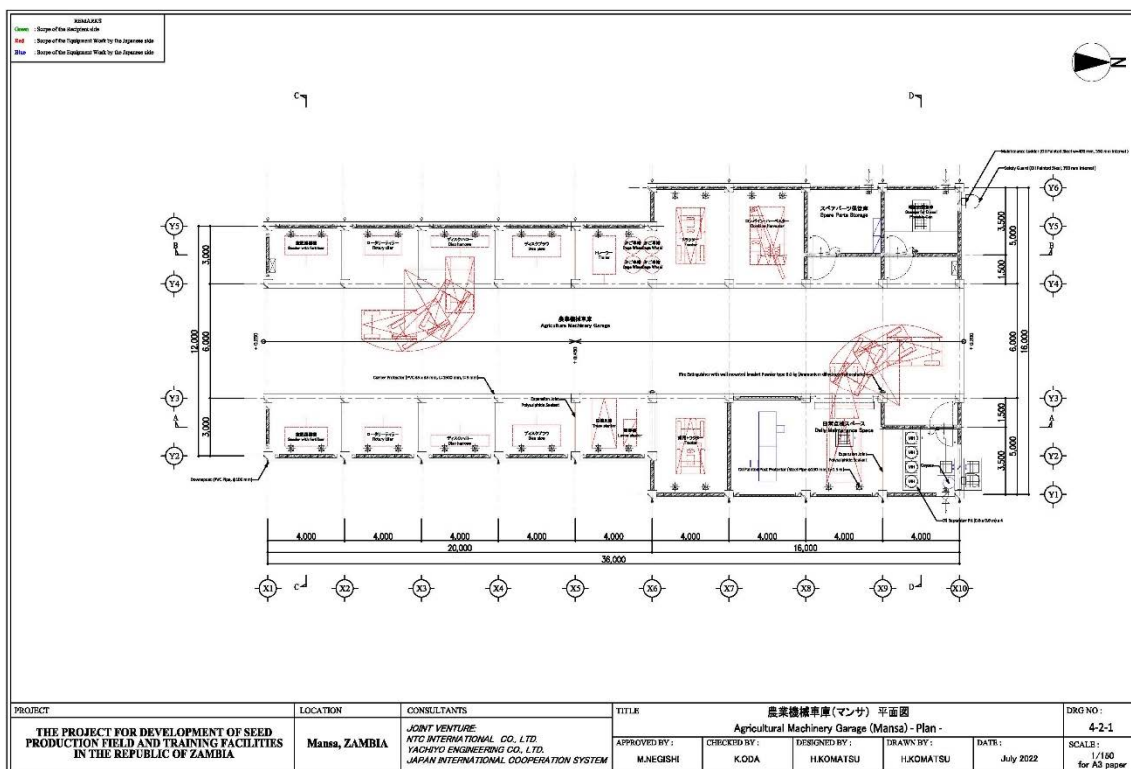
農業機械車庫の平面図(マンサ研究所)
